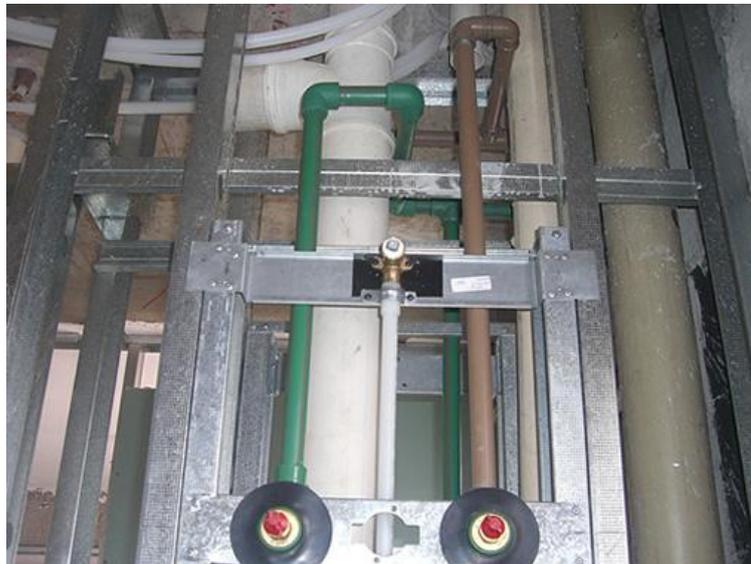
Ilustração da Instalação Hidráulica do Drywall
